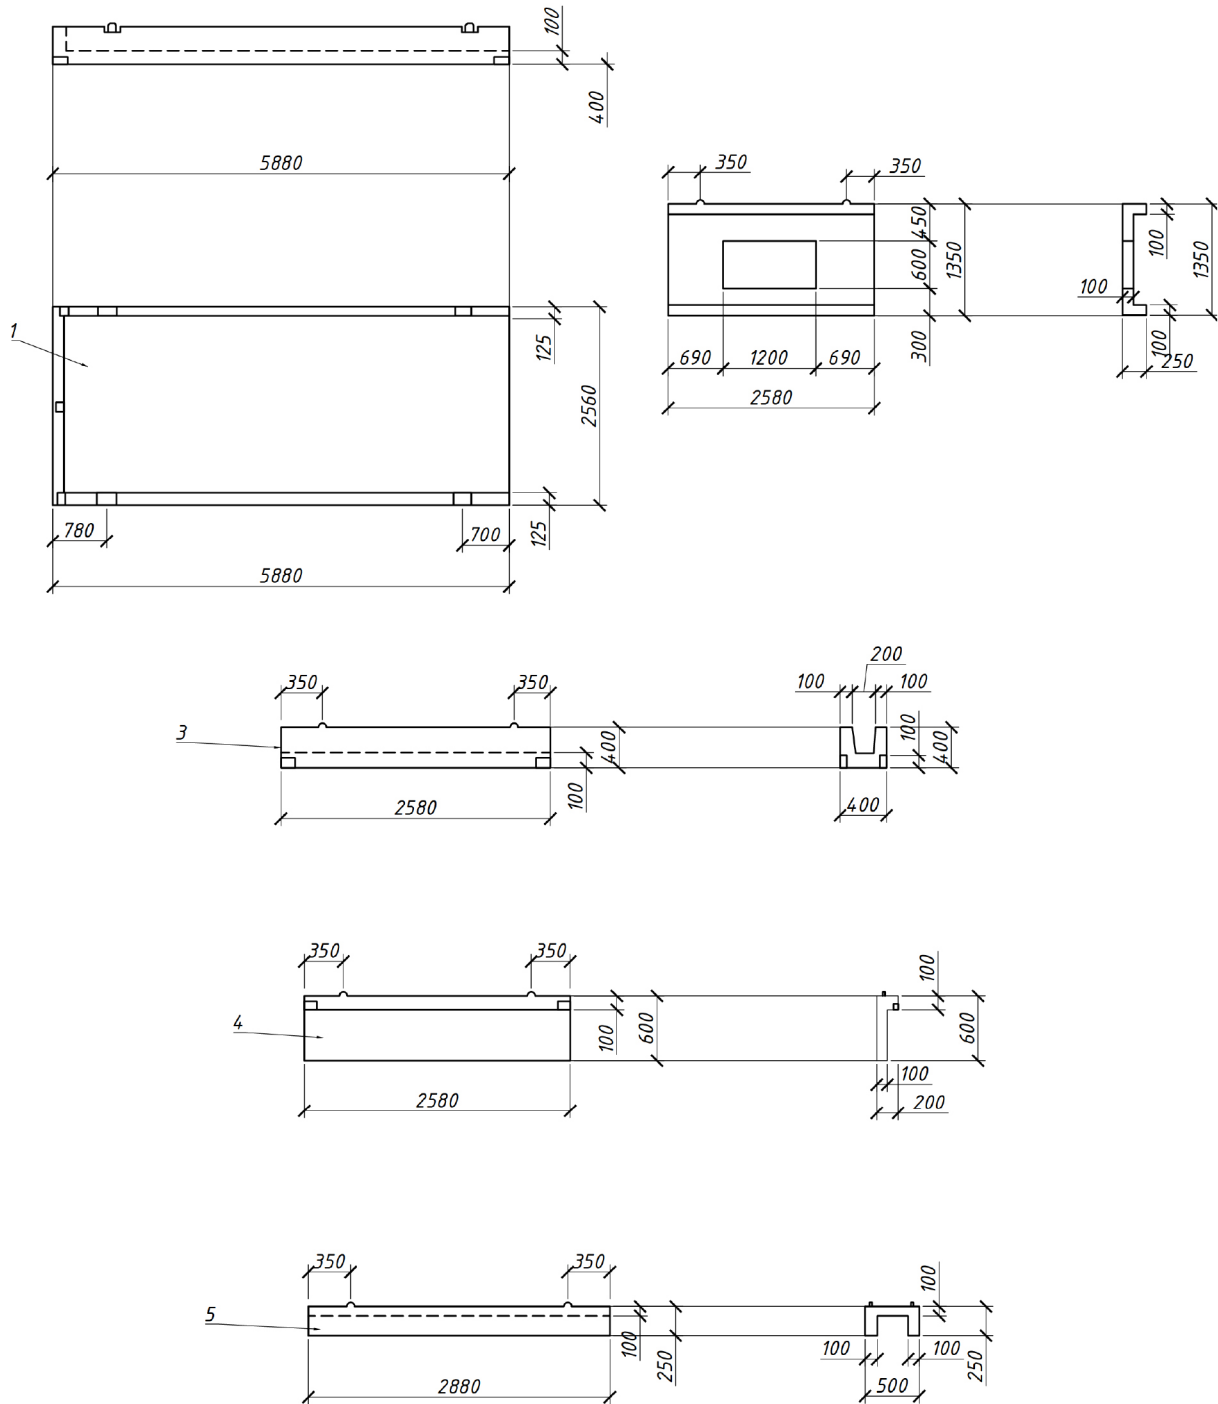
Сборные железобетонные конструкции чердачной крыши из лотковых элементов:
